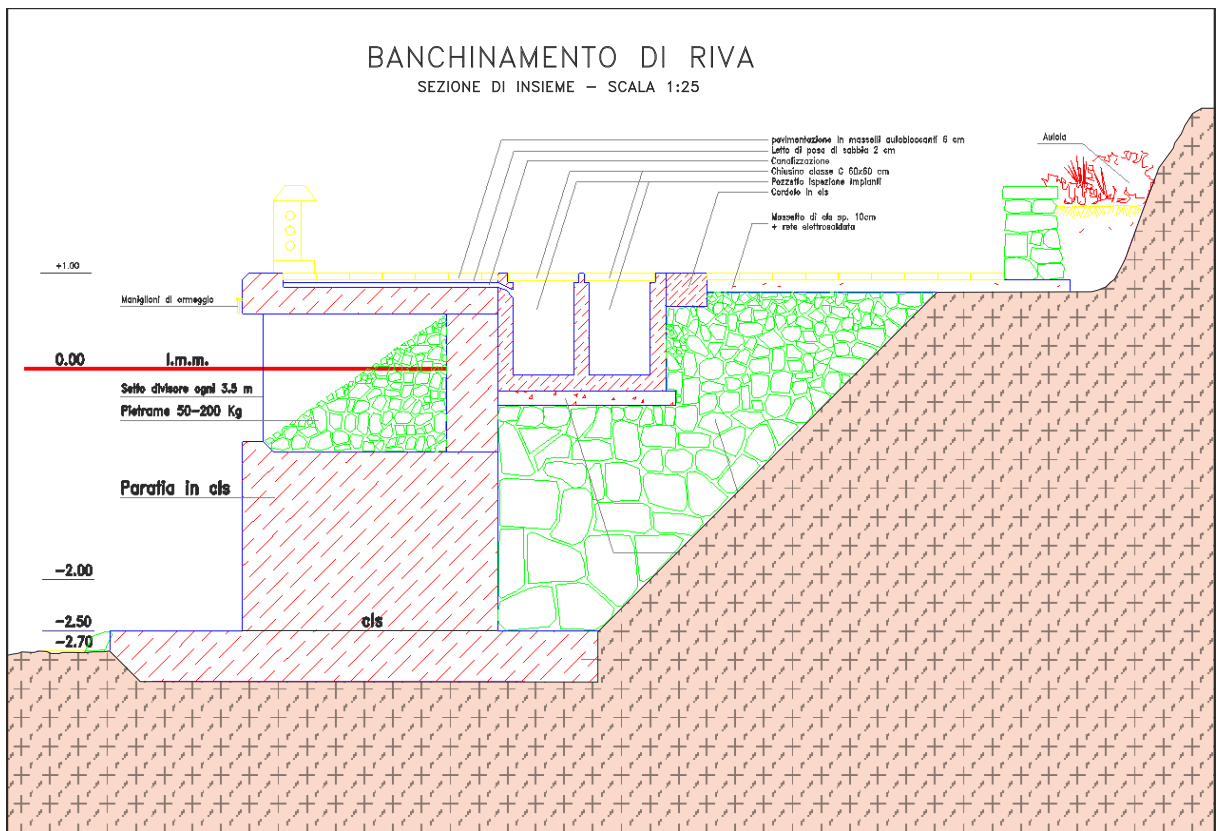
Schema della tipologia di fondazione della banchina. L'opera di fondazione in c.l.s interessa le litologie dell'Unità litotecnica B.
